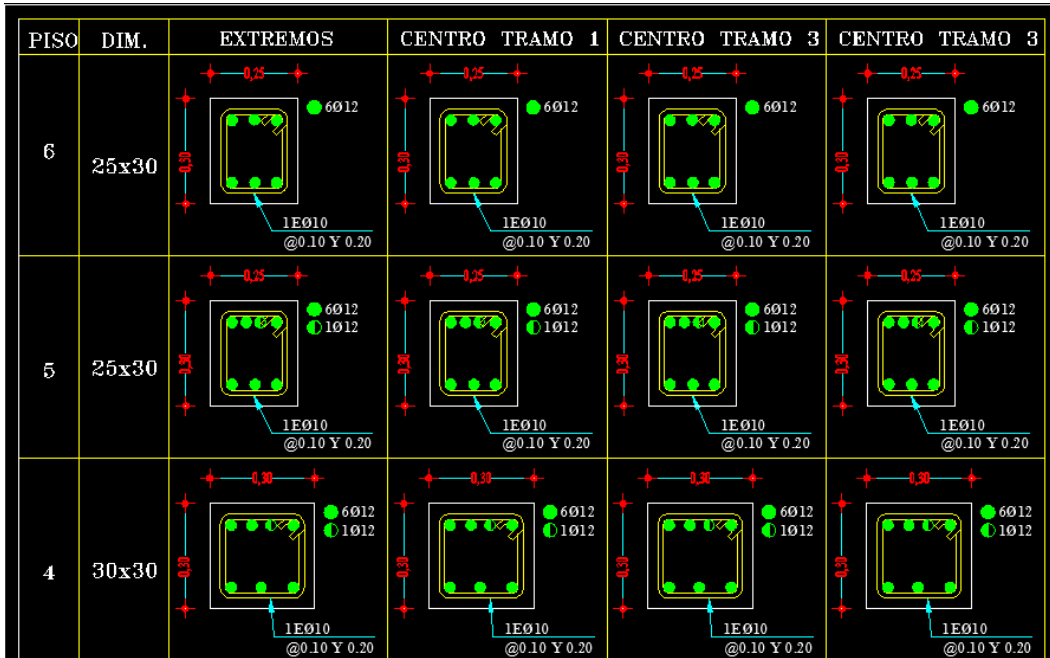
Armadura de las Vigas Edifi. 6 Pisos
